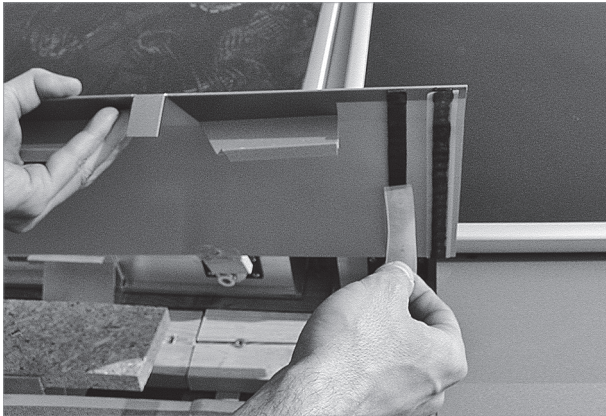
Retrait des bandes de protection situées sur la face inférieure de la tôle de croisement
